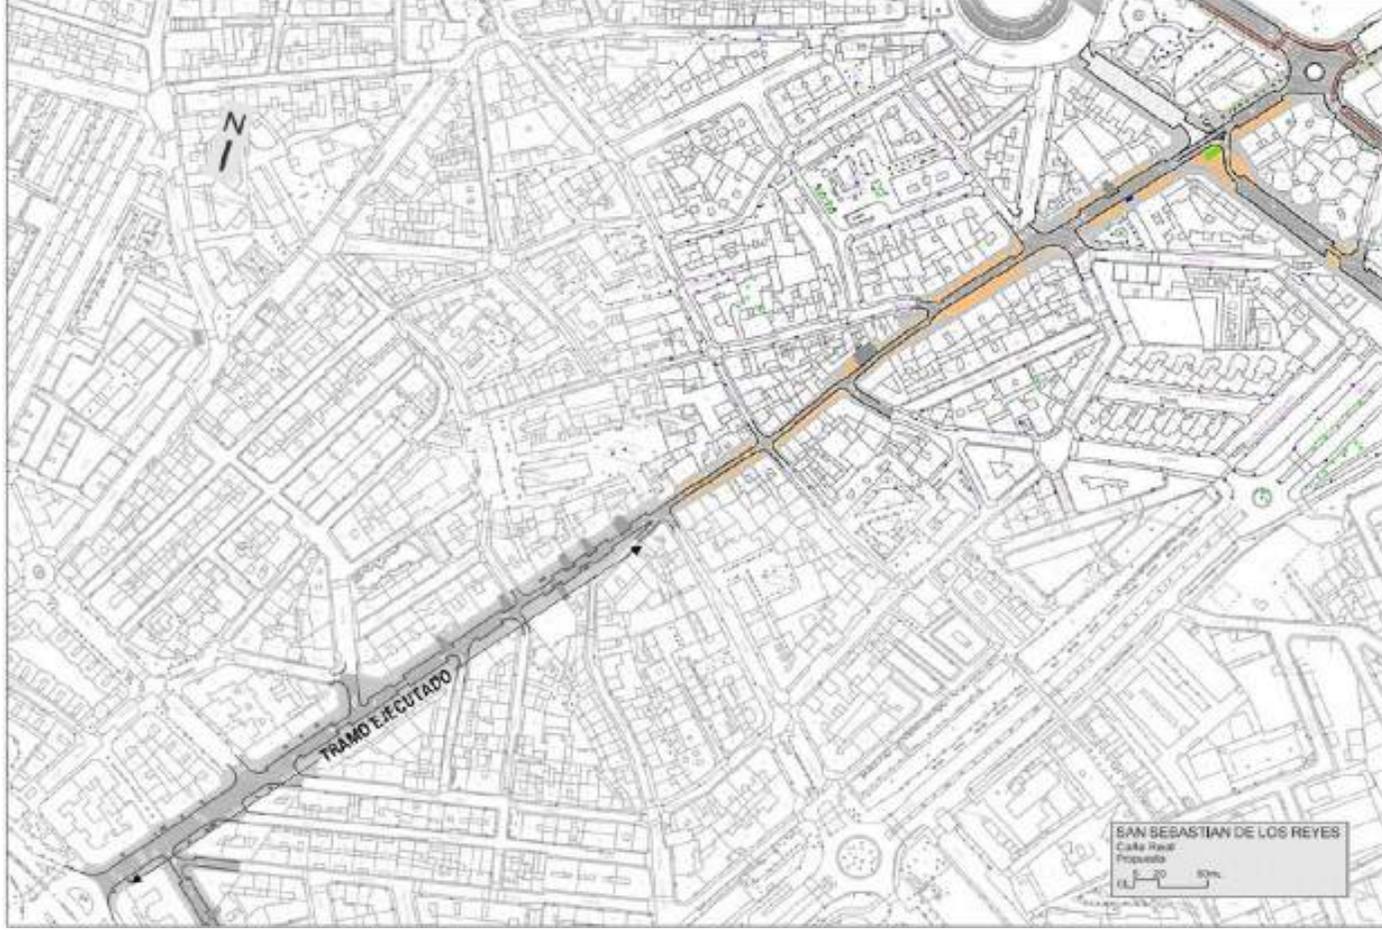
Planta propuesta para Calle Real actualizada a situación actual (2024). Fuente: DOYMO.
